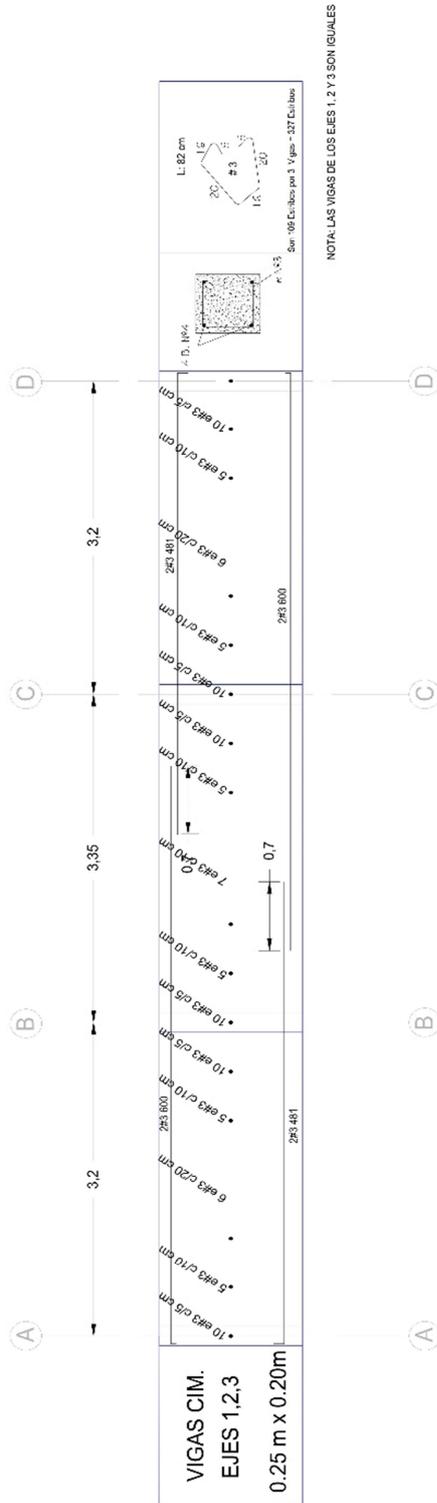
Despiece de vigas de cimentación (A, B, C y D)
